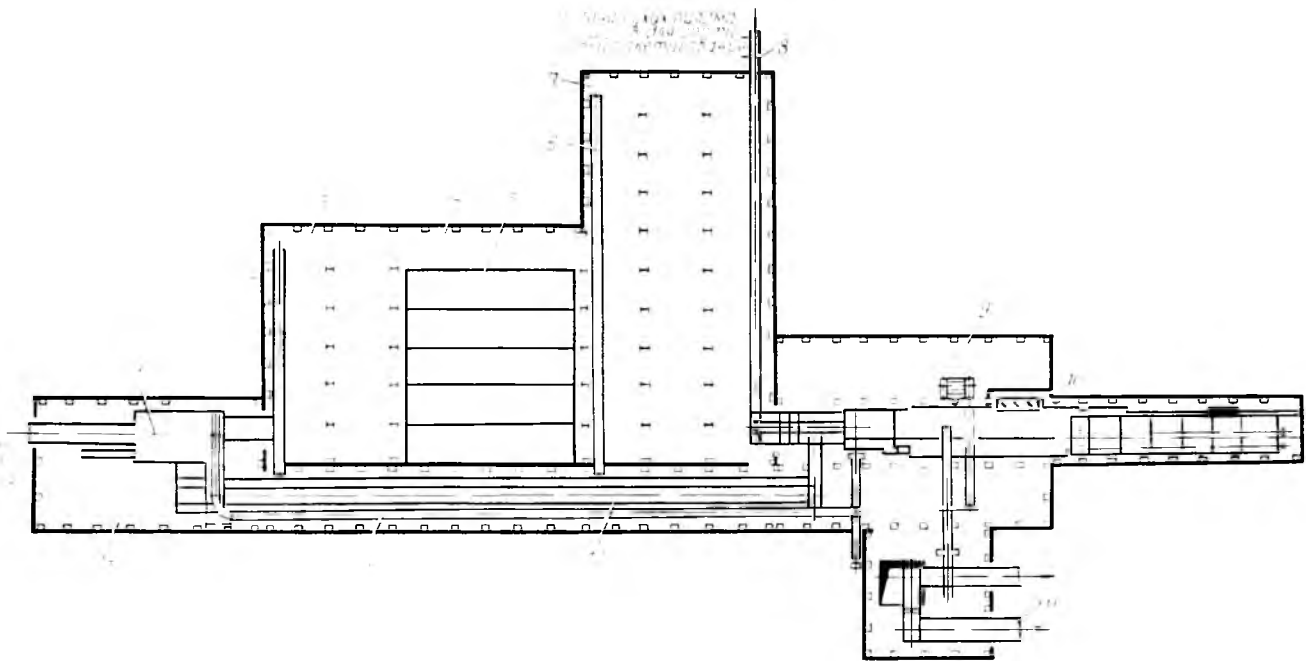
Схема цеха сушки, сортировки и пакетирования:
